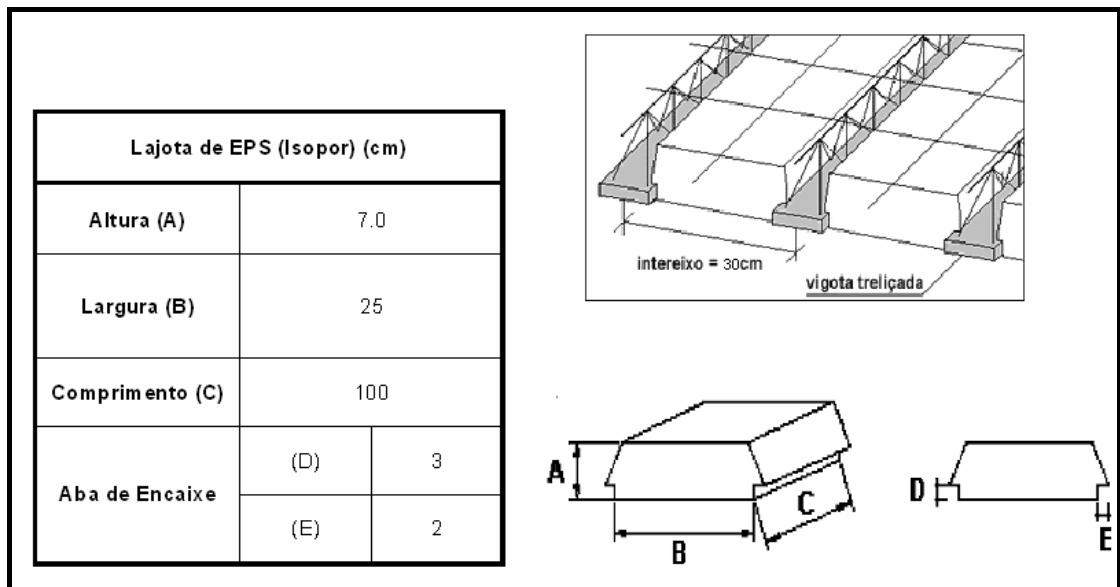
Características geométricas da laje leve adotada (fonte: www.kilaje.com.br)
